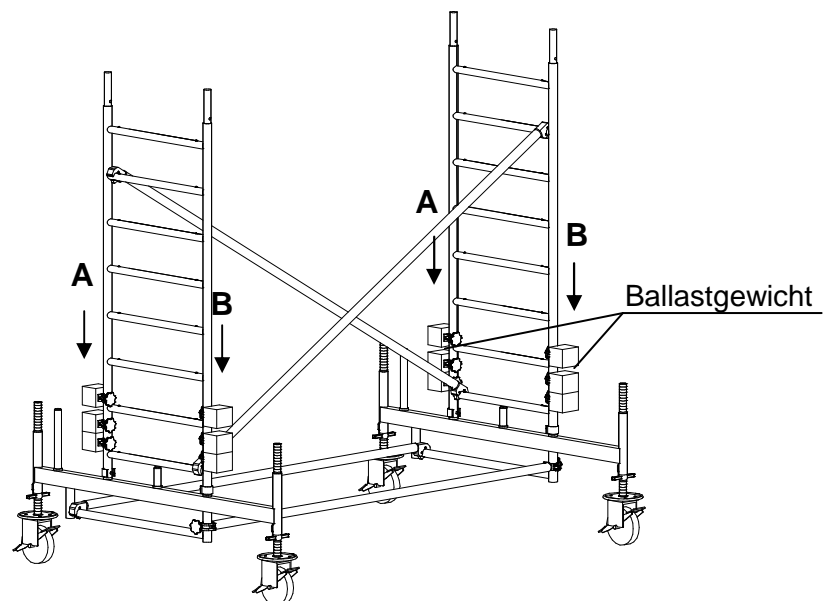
Grundeinheit mit Fahrbalken L180 und Ballast
